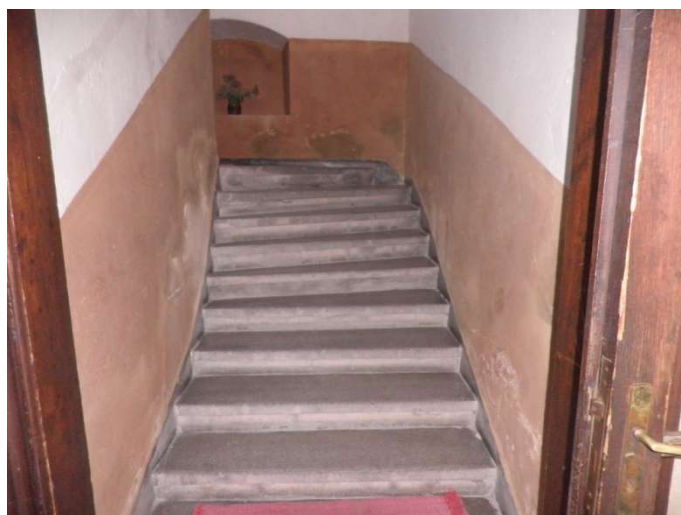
Nástupní rameno schodiště při 1.NP
